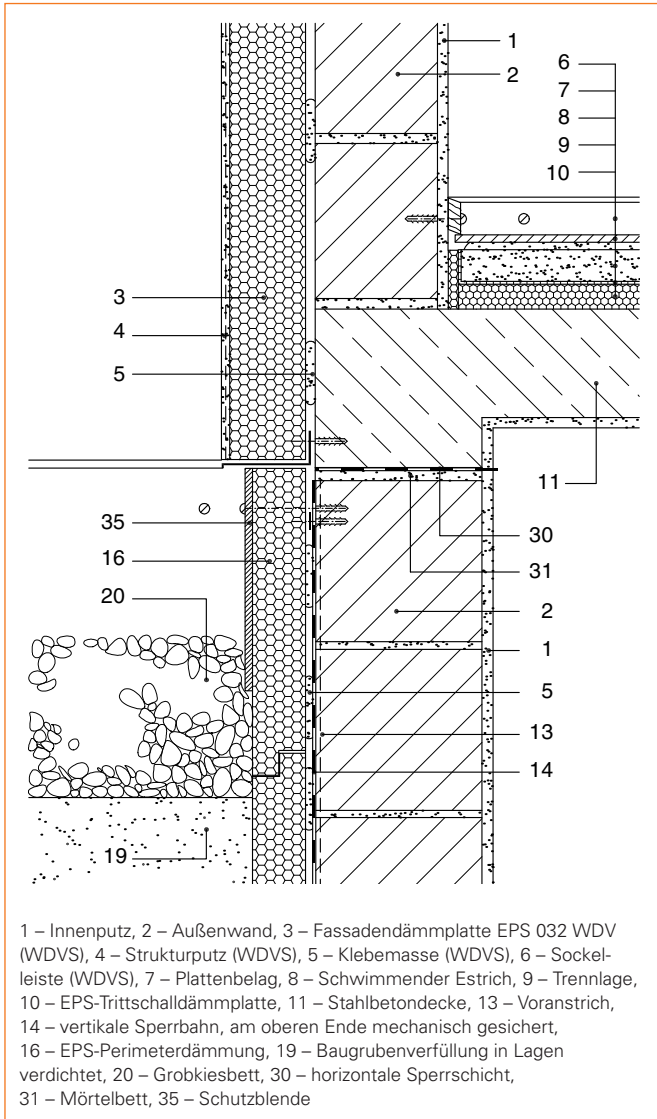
Sanierungsvariante: Kelleraußenwand mit EPS-Perimeterdämmung, hier: Sockelanschluss
